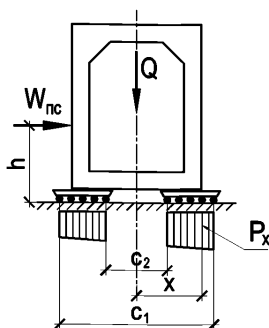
Расчетная схема давления на накаточный путь
